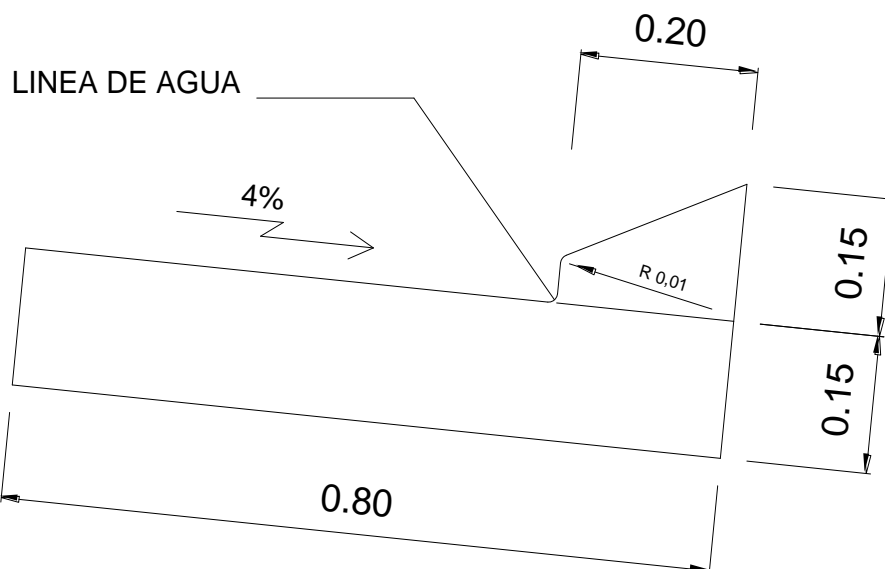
Detalle Corte Transversal Cordón Cuneta
